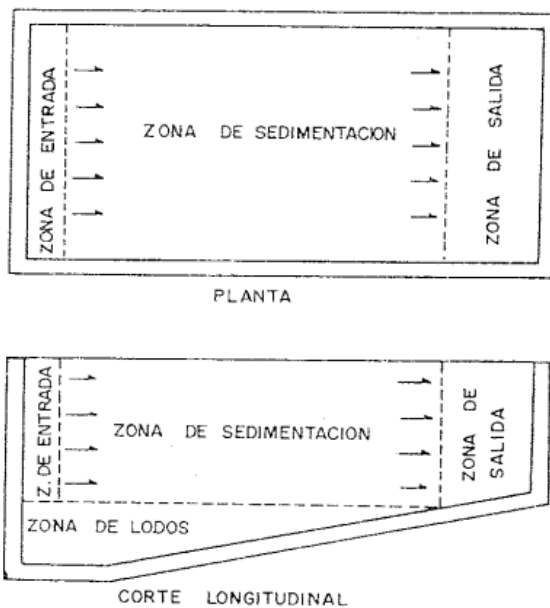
Zonas de un sedimentado (Vista en planta y corte longitudinal)
